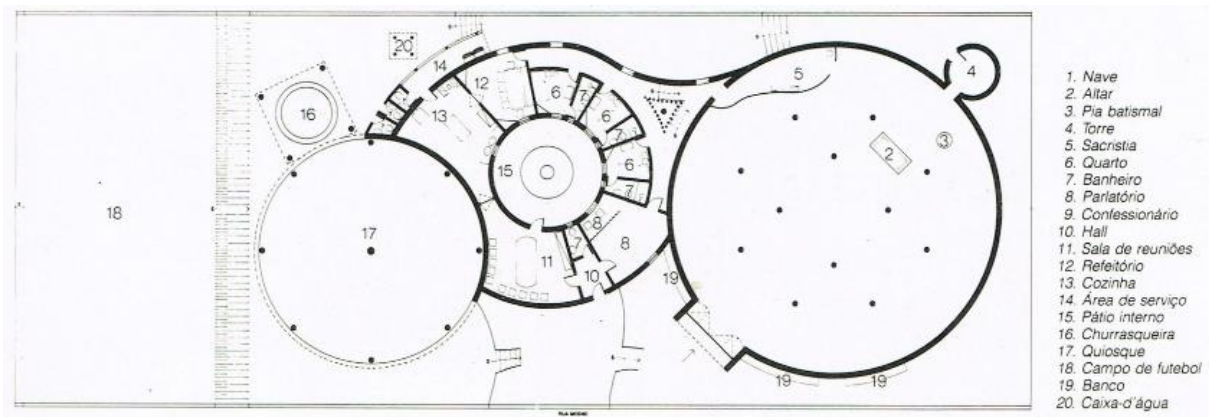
Planta baixa do conjunto arquitetônico. Fonte: Revista Projeto, p. 59.
